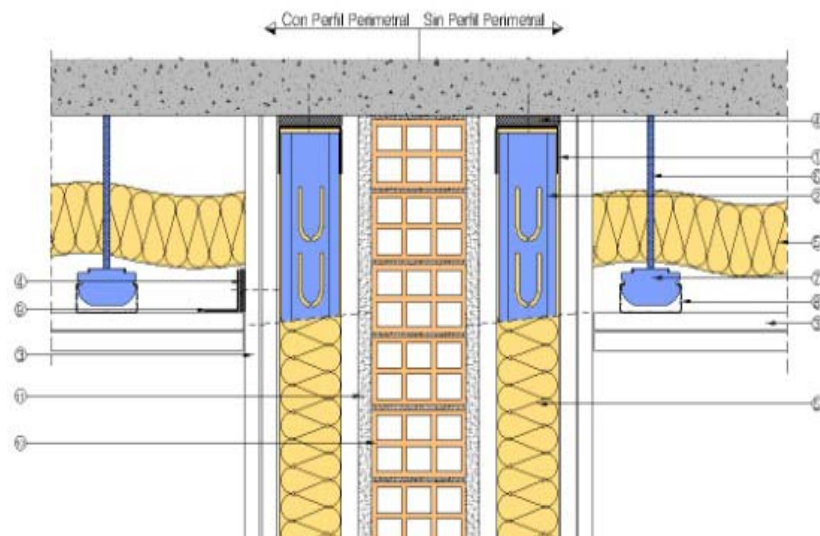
Encuentro de techo suspendido con elemento de separación vertical trasdosado
